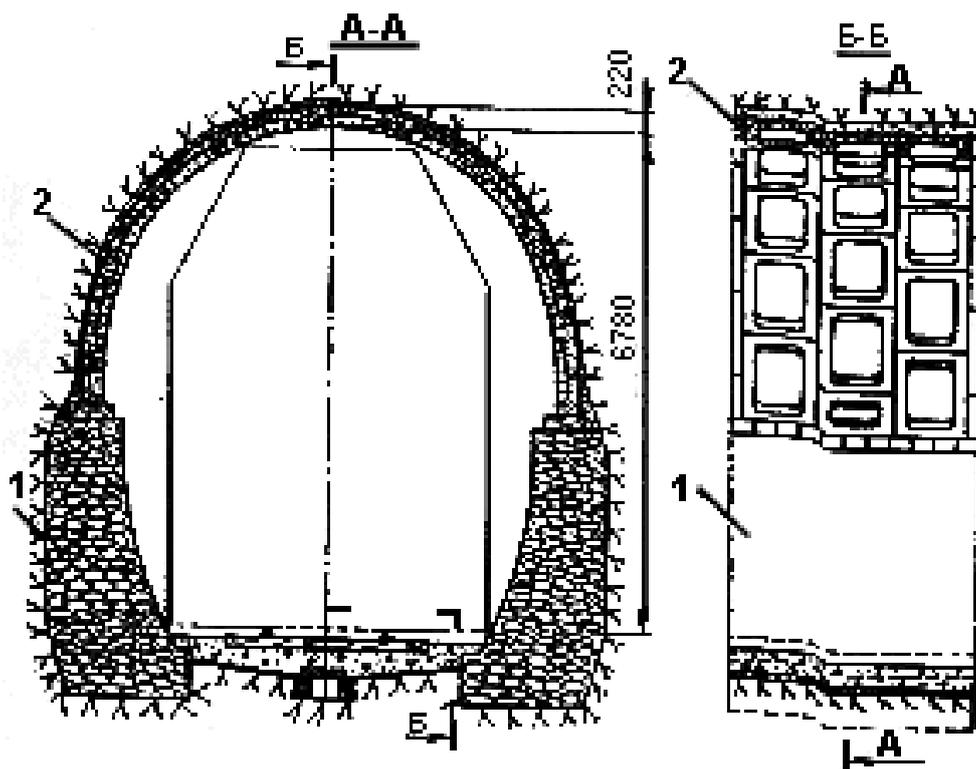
Поперечный разрез обделки после реконструкции с помощью полушита: 1 – старая каменная кладка стен; 2 – новая кладка свода из тюбингов
